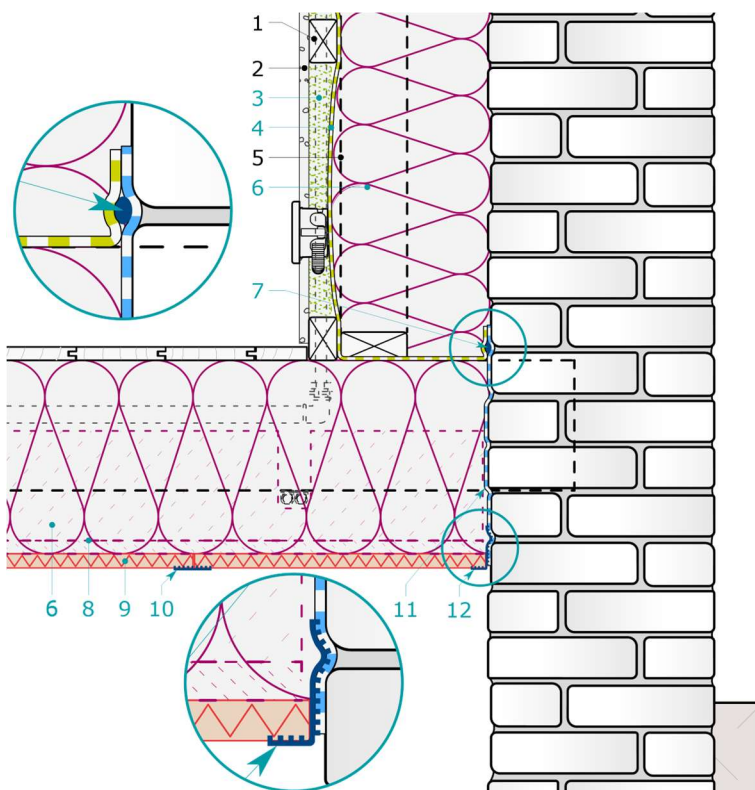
Détail mur – plancher en bois sur cave - coupe verticale perpendiculaire à la façade
